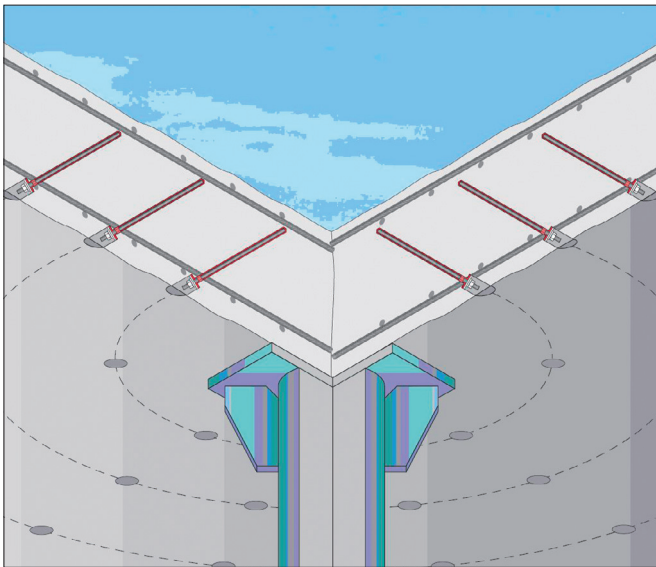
Nachträglich eingemörtelte Durchstanzbewehrung
